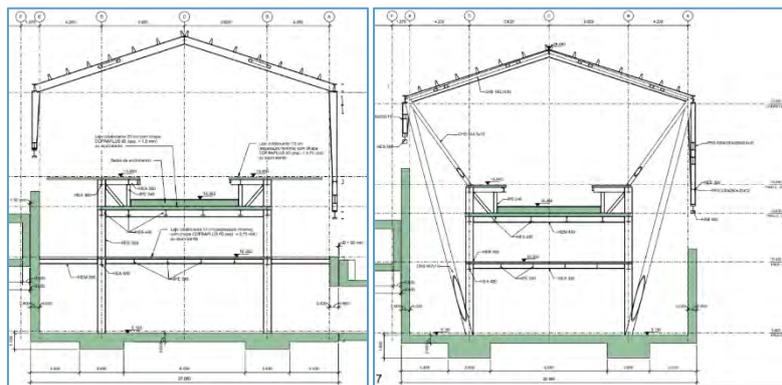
Secção transversal tipo da estrutura da estação – zona sem pilares (esquerda) e zona com pilares (direita)
